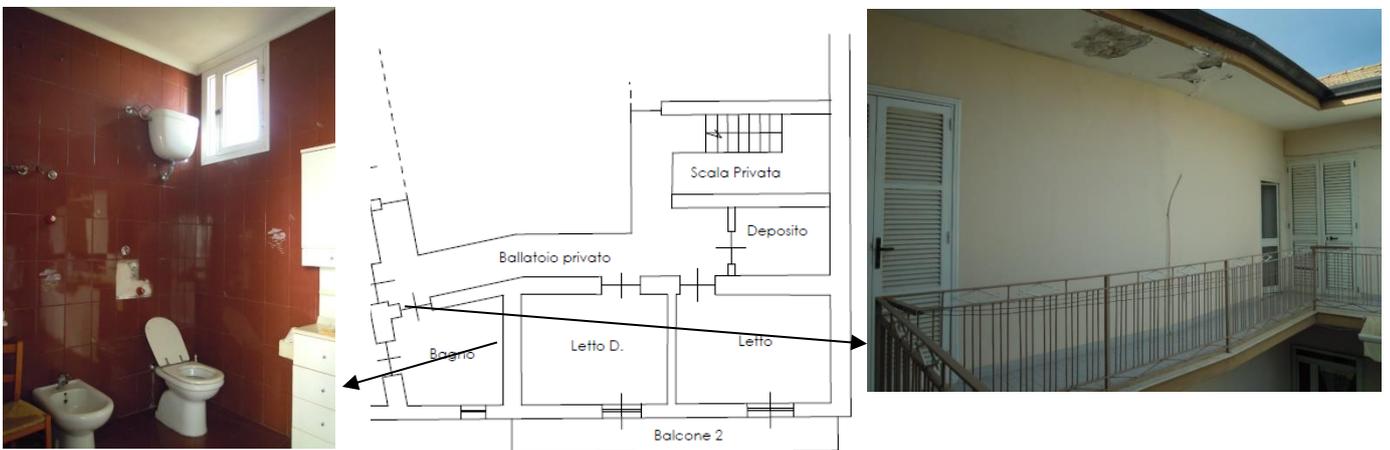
Individuazione fotografica del bagno del bene oggetto di pignoramento.
